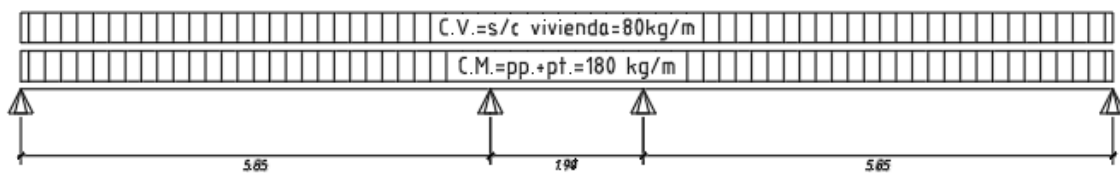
Modelo de viga del aligerado entre los ejes 3-4.
